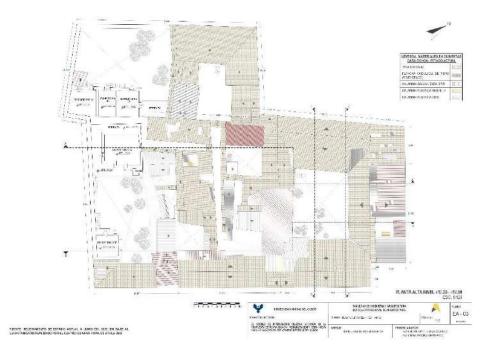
Plano de Planta de Estado Actual de la Casa Ochoa.
